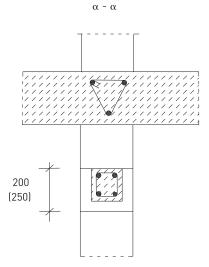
Железобетонные перемычки, изготовленные из U-образных блоков YTONG
